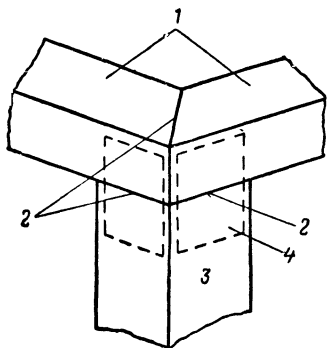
Конструктивная схема соединения профилей «в замок»: 1—детали верхнего пояса; 2—места соединения; 3—часть стойки; 4—внутренние пластины.
